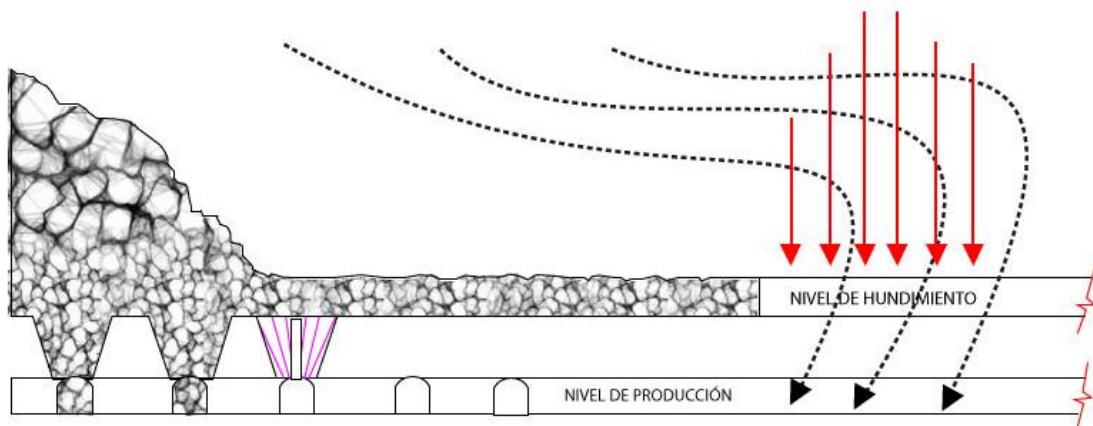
Estado tensional en Hundimiento Avanzado. (Modificado de Cavieres, 1999)
